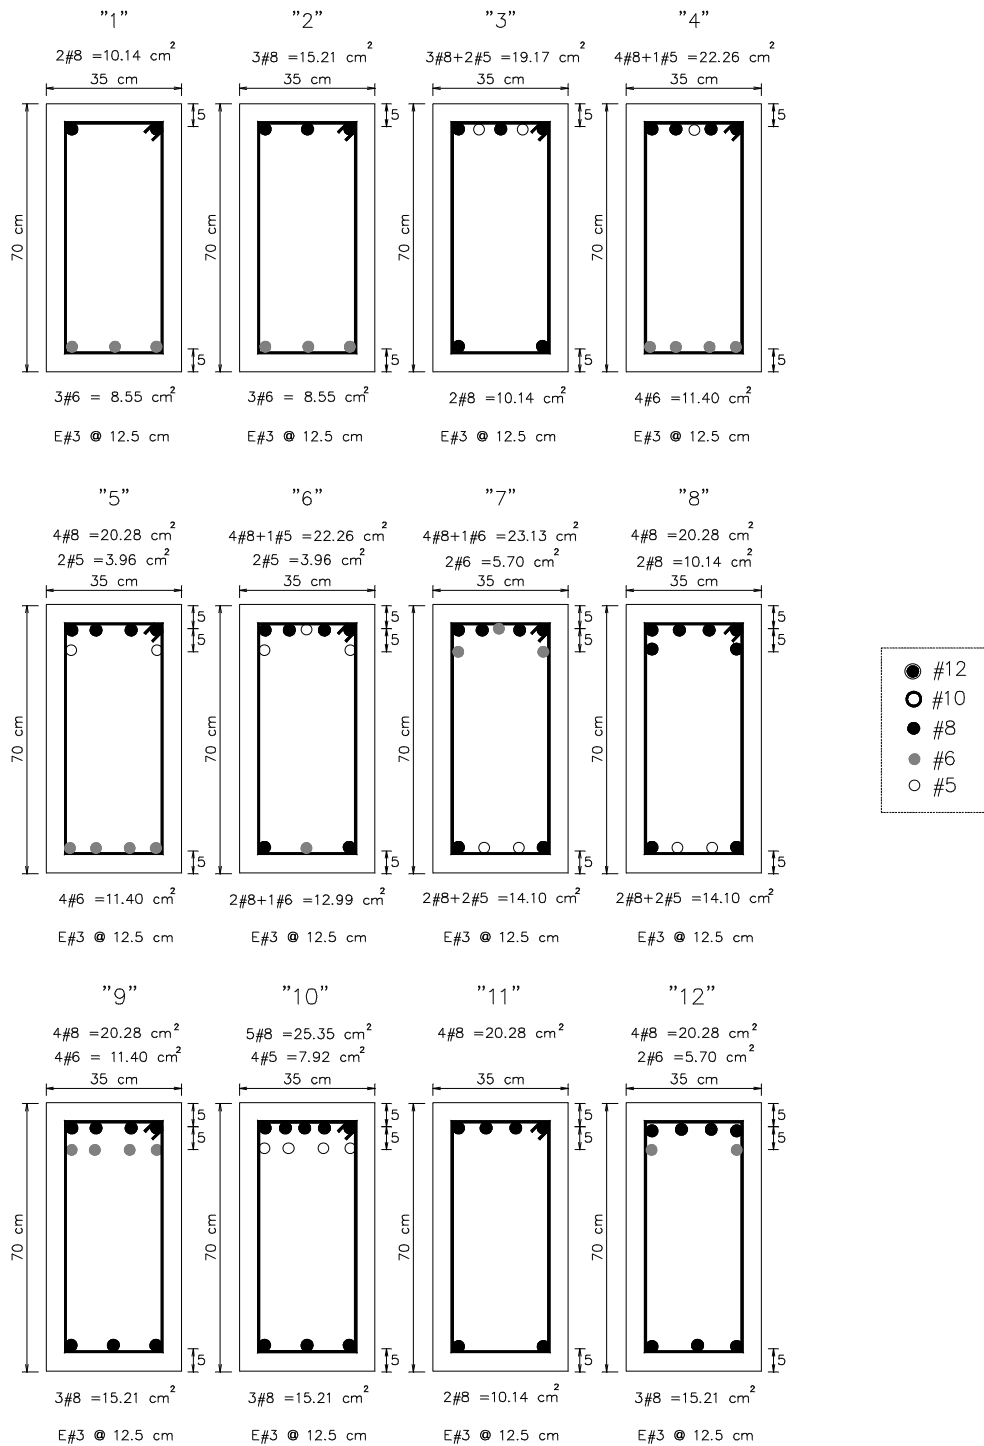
Tipos de armados propuestos para las vigas del eje 2, estructuras de 7 niveles diseñadas en zona II (RDF-93 y RDF-04)
